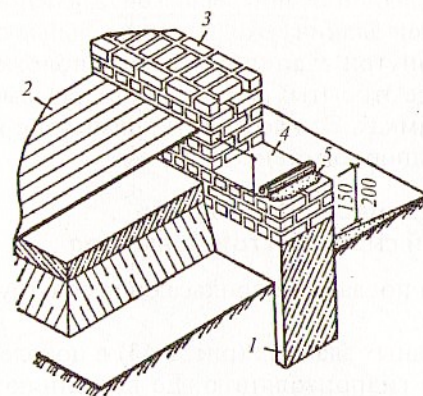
Горизонтальная гидроизоляция стены бесподвальных зданий:
